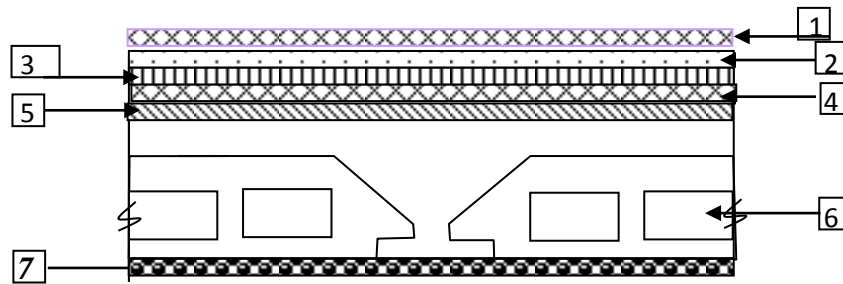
Coupe transversale d'un plancher terrasse inaccessible.
